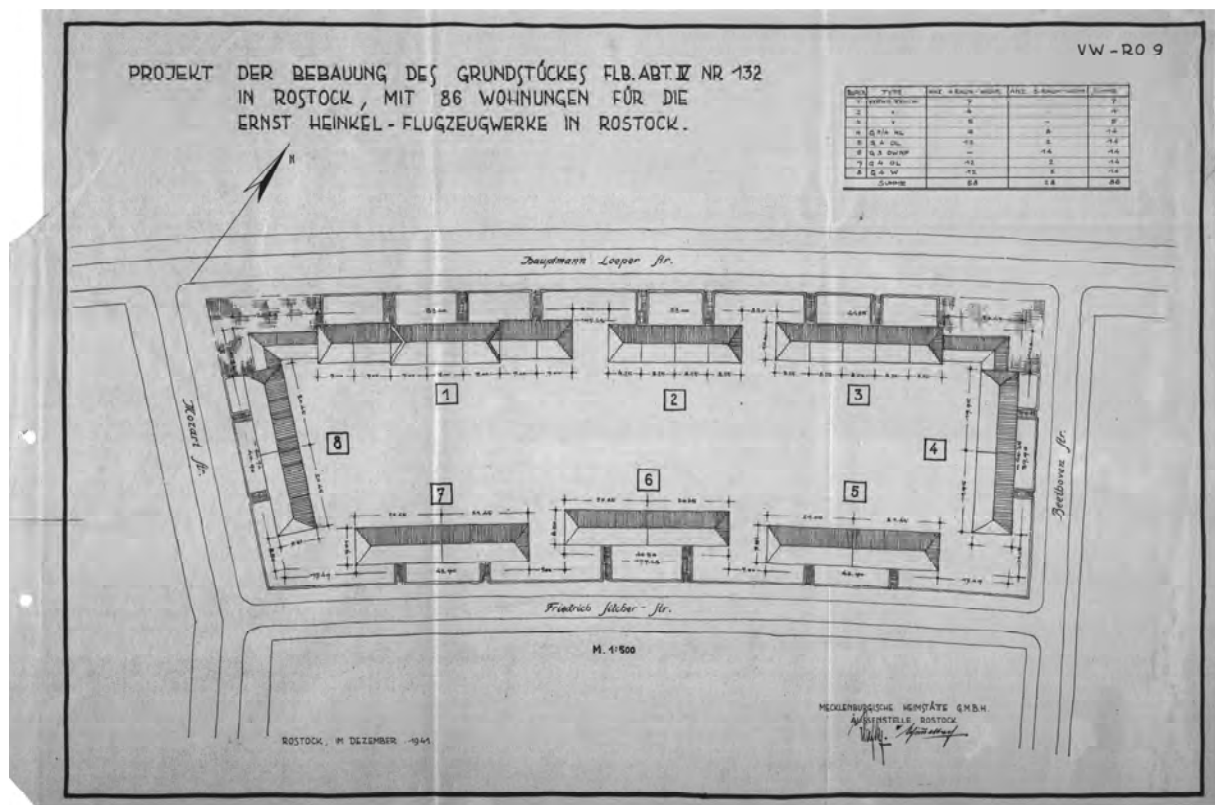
Grundriss des Baublocks 132; Quelle: Stadtarchiv Rostock
